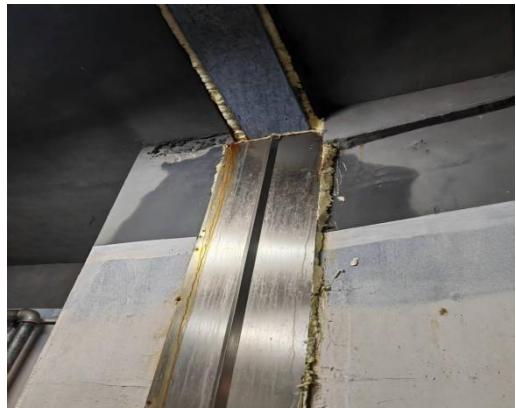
后浇带两侧混凝土开裂渗漏
